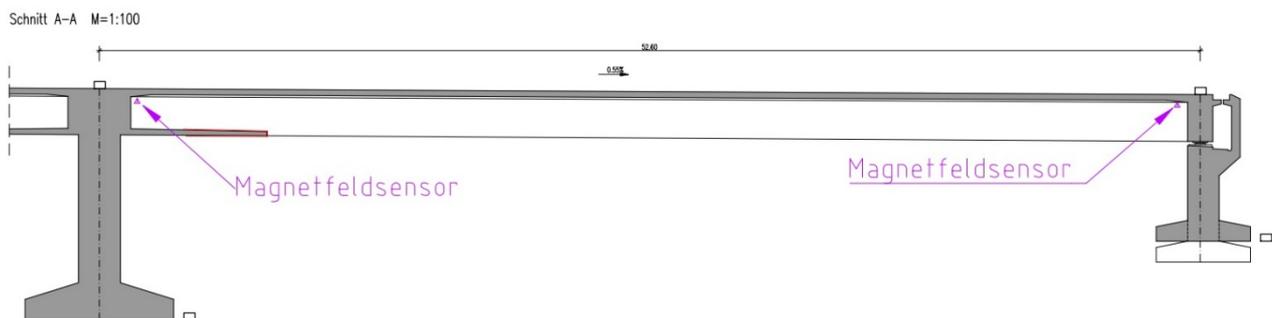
Lage der Magnetfeldsensoren in der Ansicht; Quelle: Büro für Strukturmechanik GmbH
